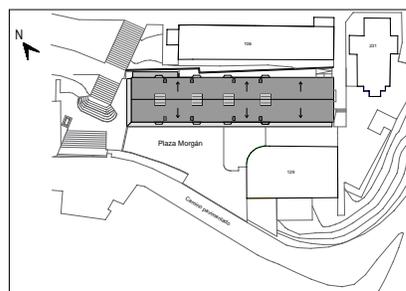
Emplazamiento edificio N°125, Base planimétrica, Fundación Sewell (fuente: Elaboración propia, 2019).
